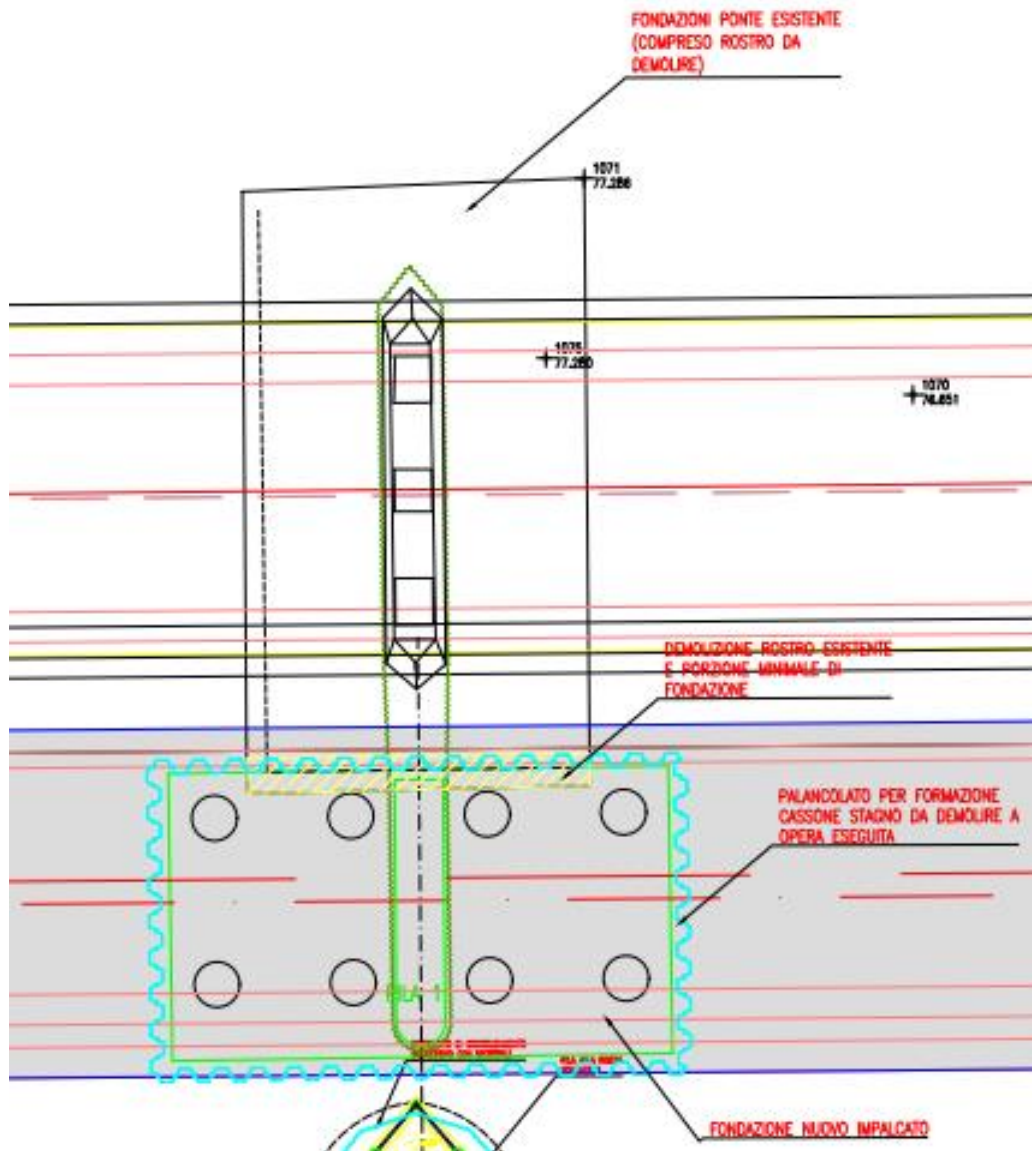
Particolare della planimetria del nuovo ponte in progetto
